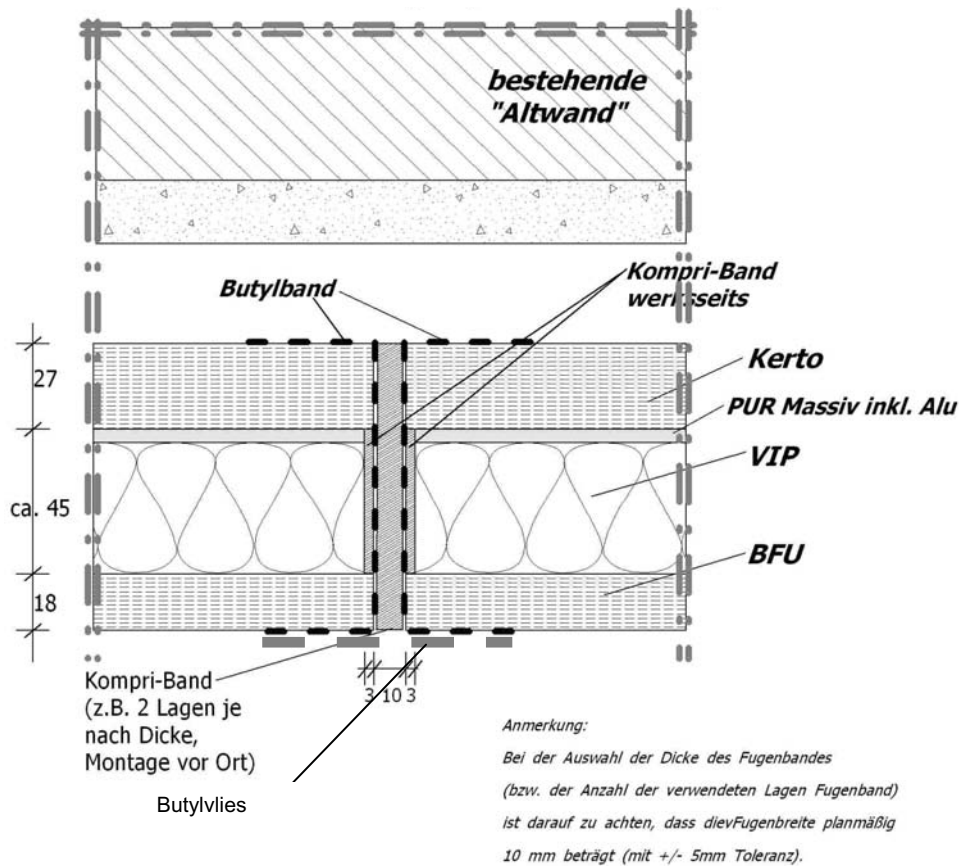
Horizontalschnitt durch eine vertikale GE-GE-Fuge mit planmäßiger GEDT-Fugen-Breite von 10 mm¹
